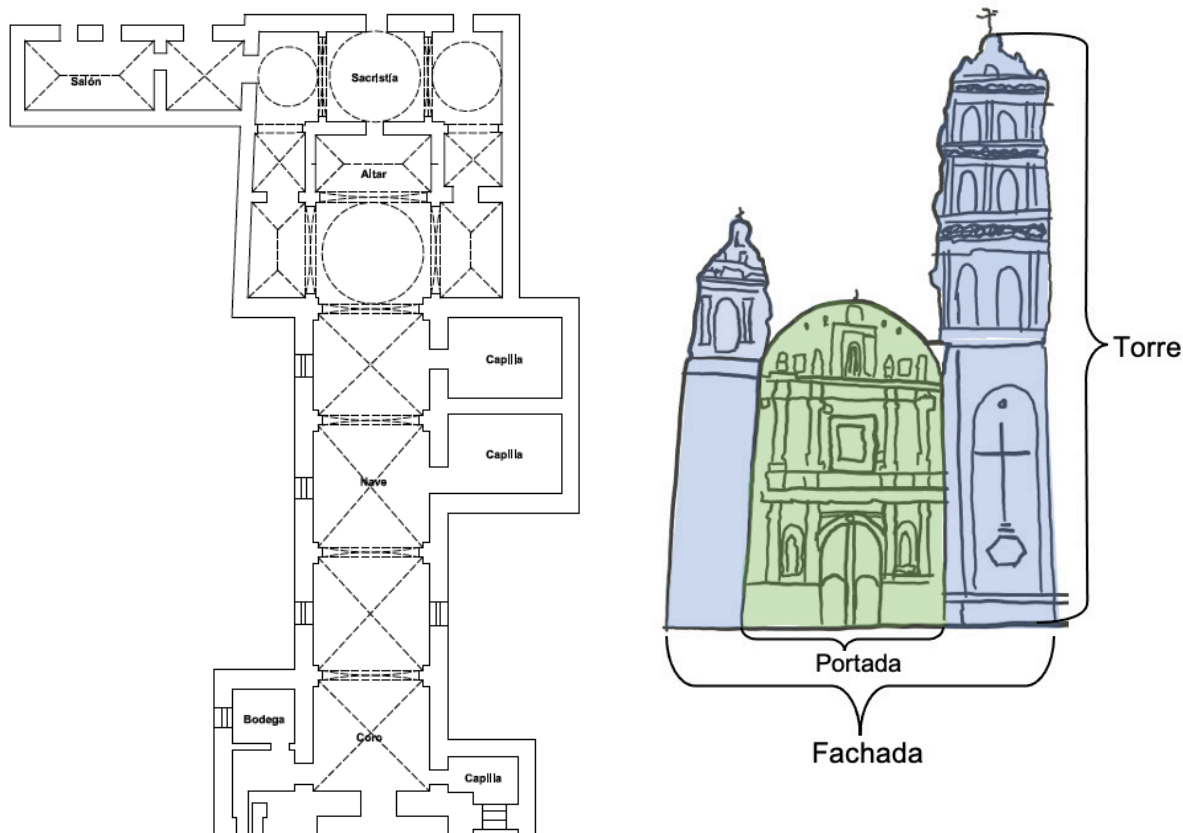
planta arquitectónica (INAH 2022) y diagramas de elementos que conforman la fachada del Templo de San Agustín.
